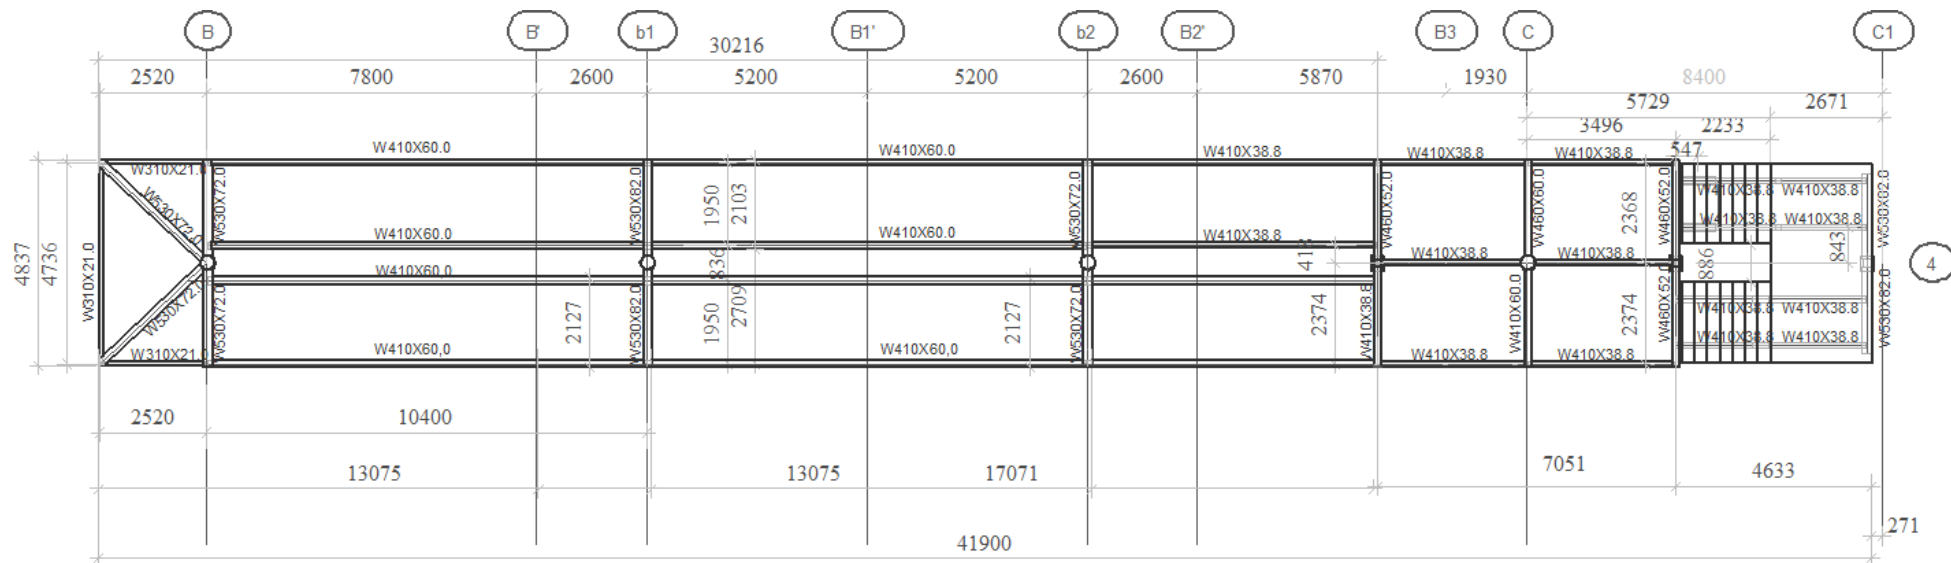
Planta de Elevação Nível +2800 até +6400.
